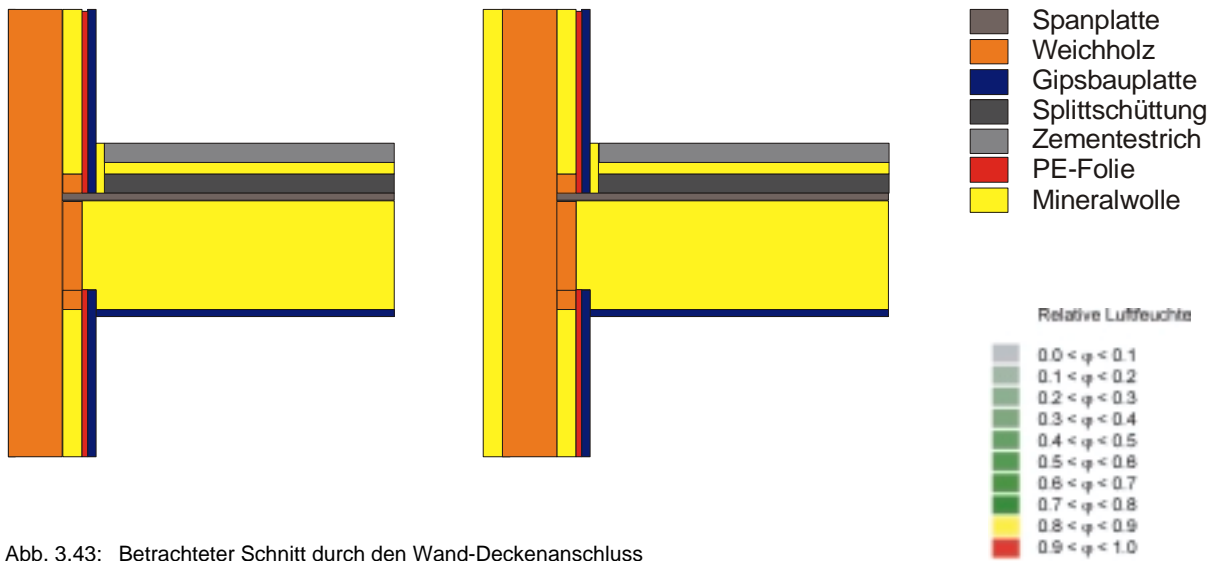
Betrachteter Schnitt durch den Wand-Deckenanschluss ohne (links) und mit (rechts) zusätzlicher außen liegender Wärmedämmung
